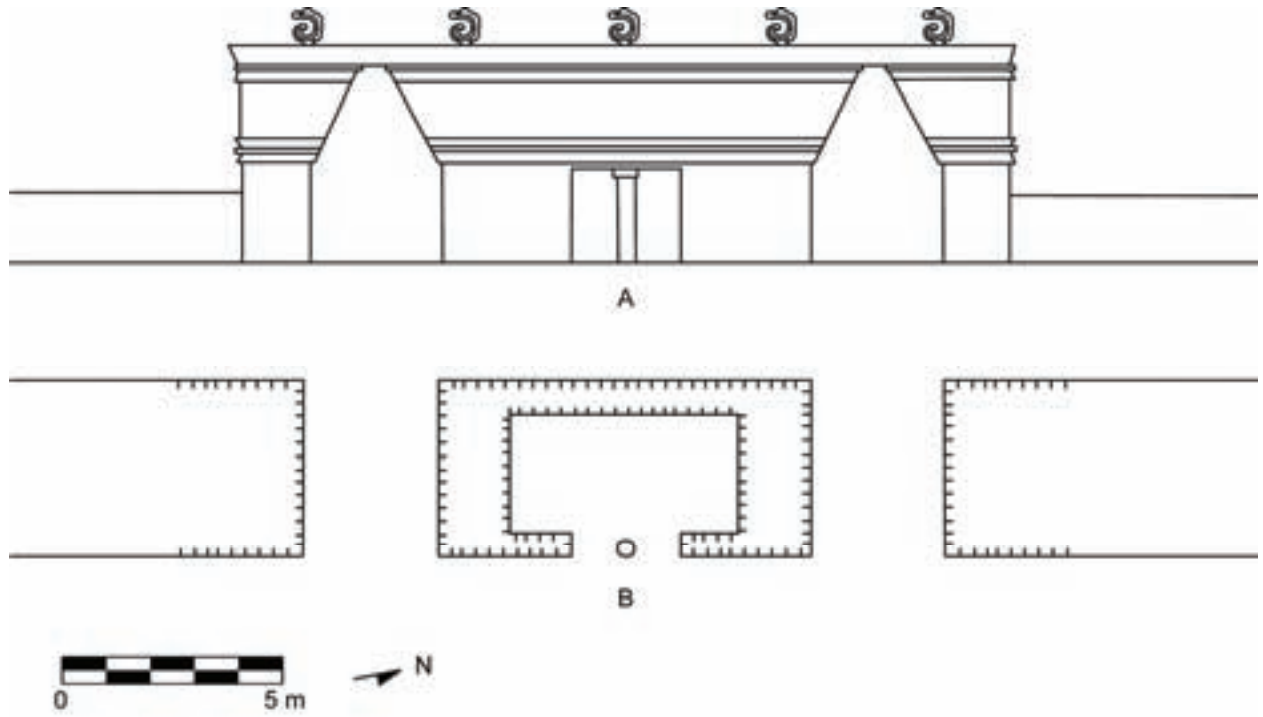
Puerta Occidental: (a) Reconstrucción hipotética; (b) Planta (Según Ruz Lhuillier 1948).
